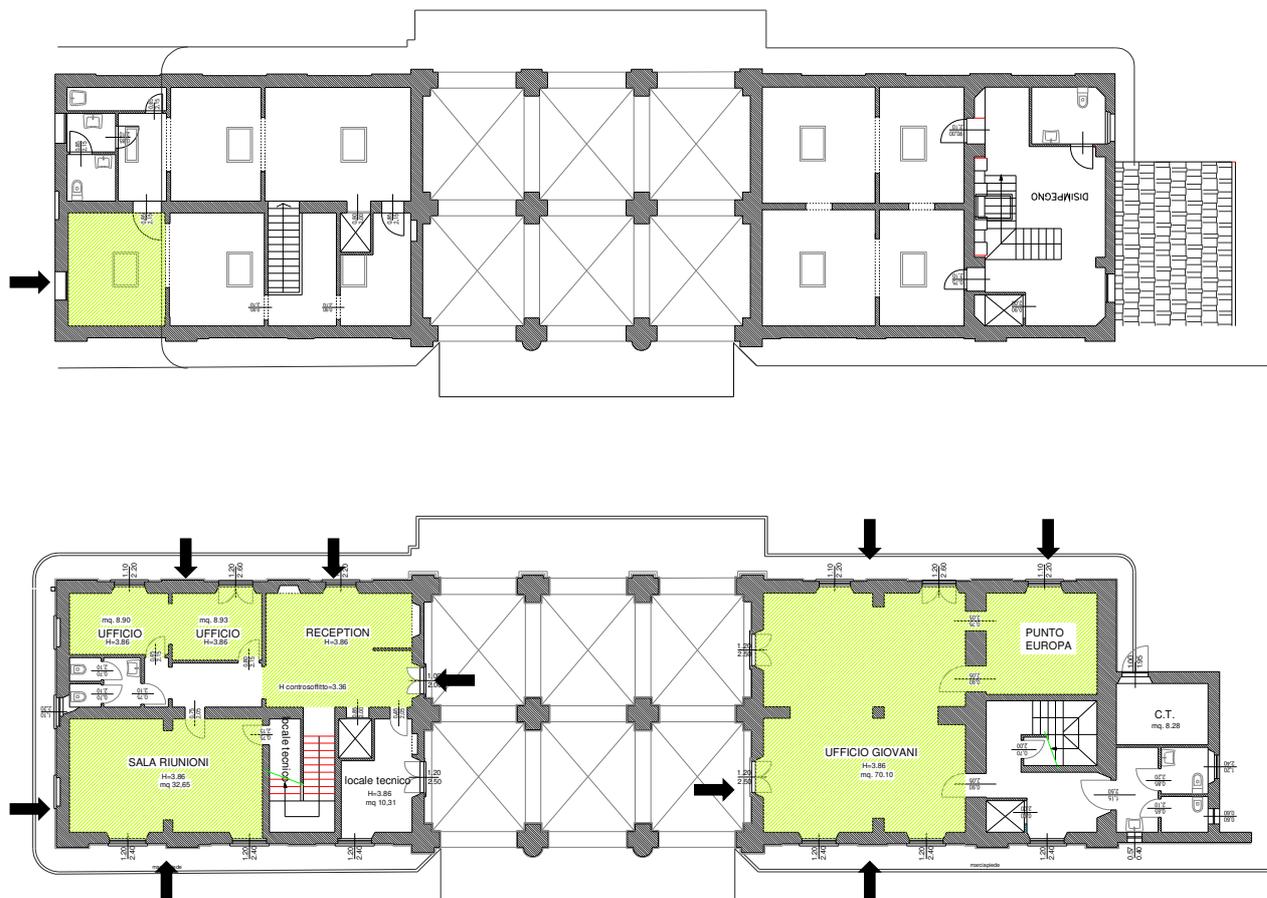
Pianta piano terra e primo dell'edificio con indicazione degli "ambienti abitativi" e delle pareti di facciata oggetto di verifica
